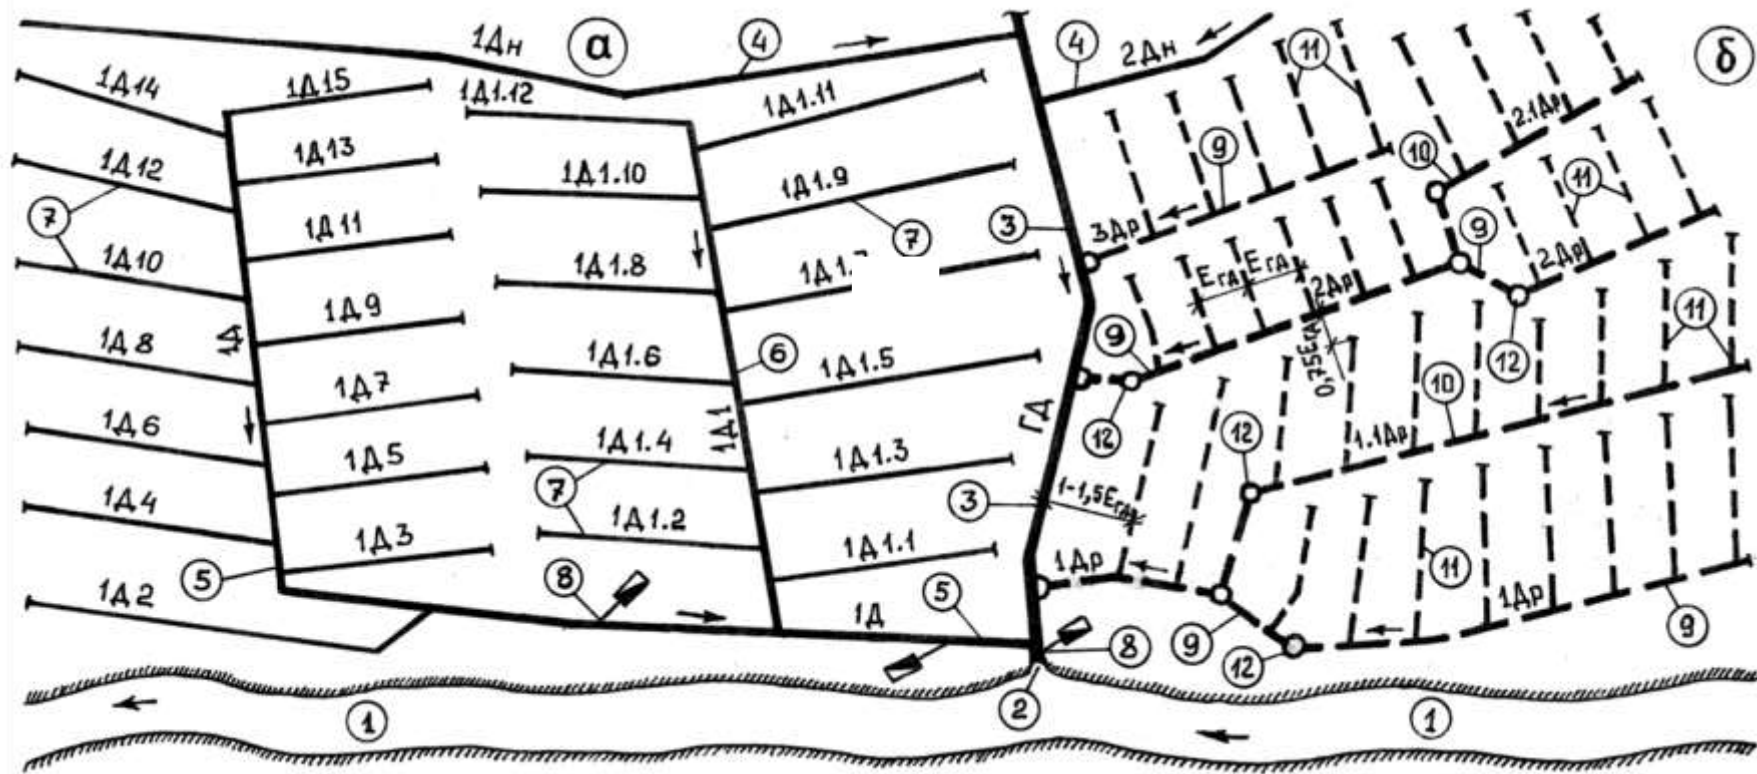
Схеми та основні споруди систем горизонтальних систематичних відкритого поздовжнього (а) і закритого поперечного (б) дренажів: 1 – водоприймальник (ВО); 2 – випуск дренажних вод; 3 – магістральний канал (ГД) або провідний канал першого порядку; 4 – нагірні канали (1Дн, 2Дн); 5 – провідний канал другого порядку (1Д); 6; 7 – регулювальні канали, відповідно, першого (1Д1–1Д15) і другого (1Д1.1–1Д1.12) порядків; 8 – шлюзи-регулятори, суміщені з переїздами; 9; 10 – провідні колектори, відповідно першого (1Д–3Др) і другого (1.1Др, 2.1Др) порядків; 11 – дрени закритої регулювальної мережі, відстань між якими  $E_{ГД}$ ; 12 – колодязі
